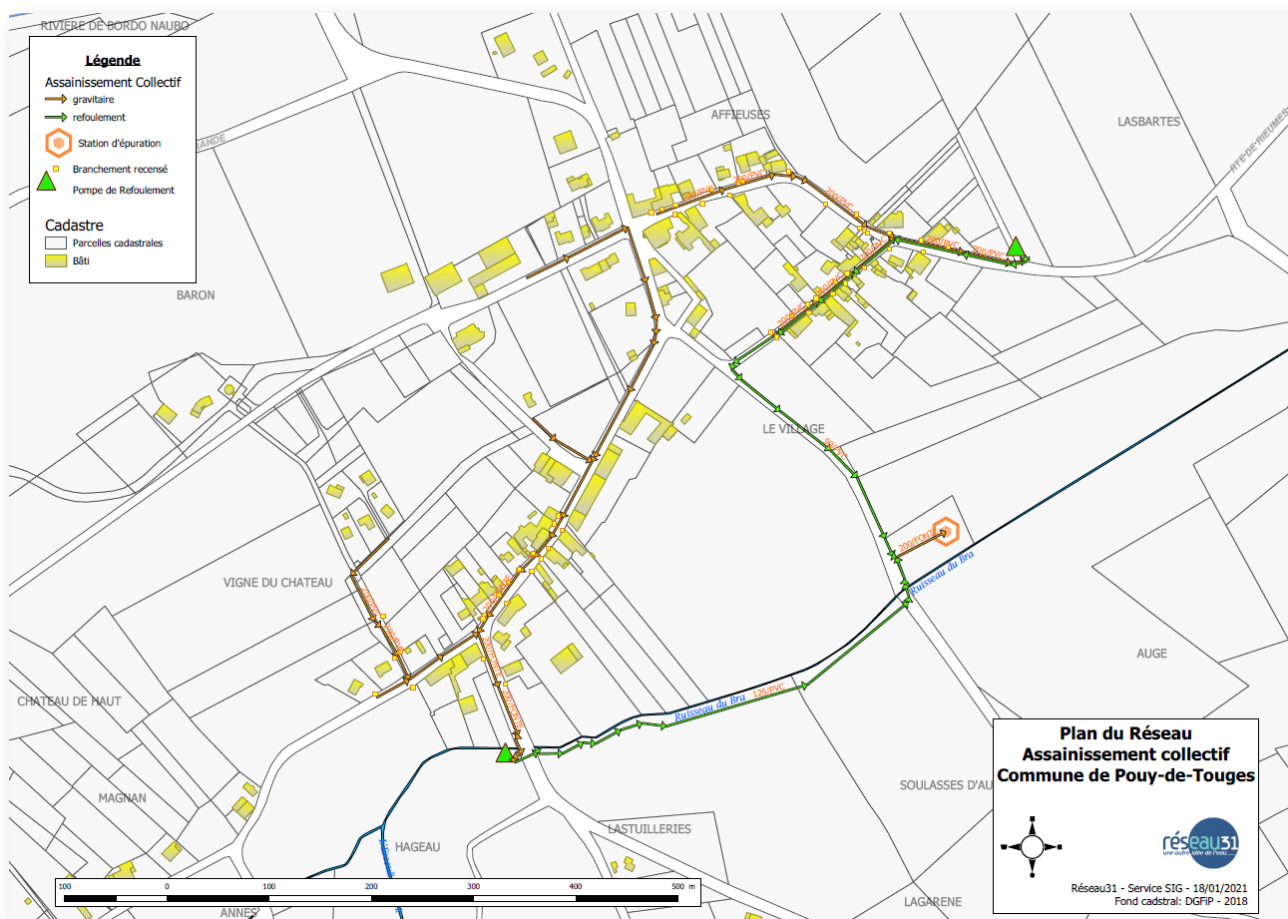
Réseau d'assainissement collectif (réseau 31)
